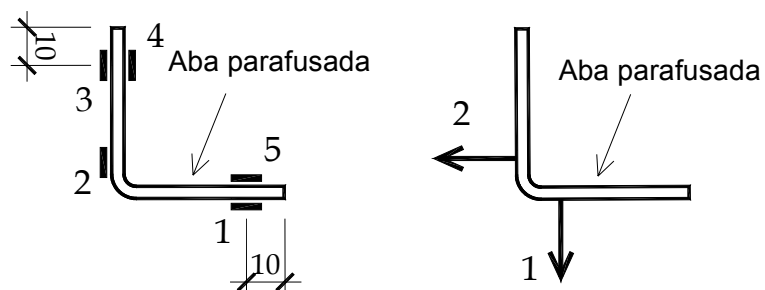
Posição dos extensômetros e transdutores de deslocamento: perfil L 60x2,25: barras tipos III e IV (dimensões em mm)
